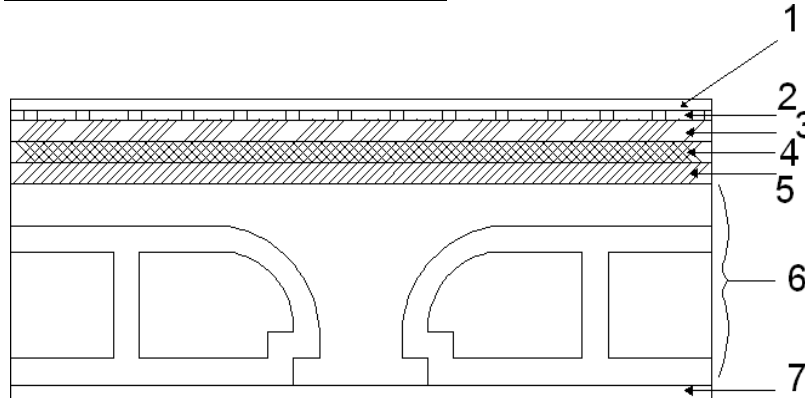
Coupe transversale d'un plancher à corps creux (Plancher terrasse)
